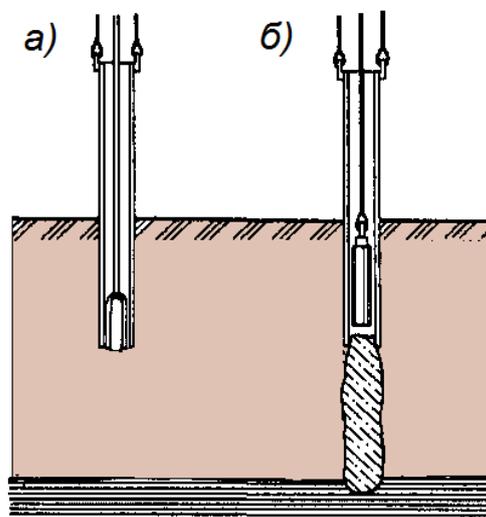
Схема устройства свай Страуса: а) - бурение скважины при помощи желонки; б) – заполнения скважины бетоном с одновременным уплотнением трамбовкой
